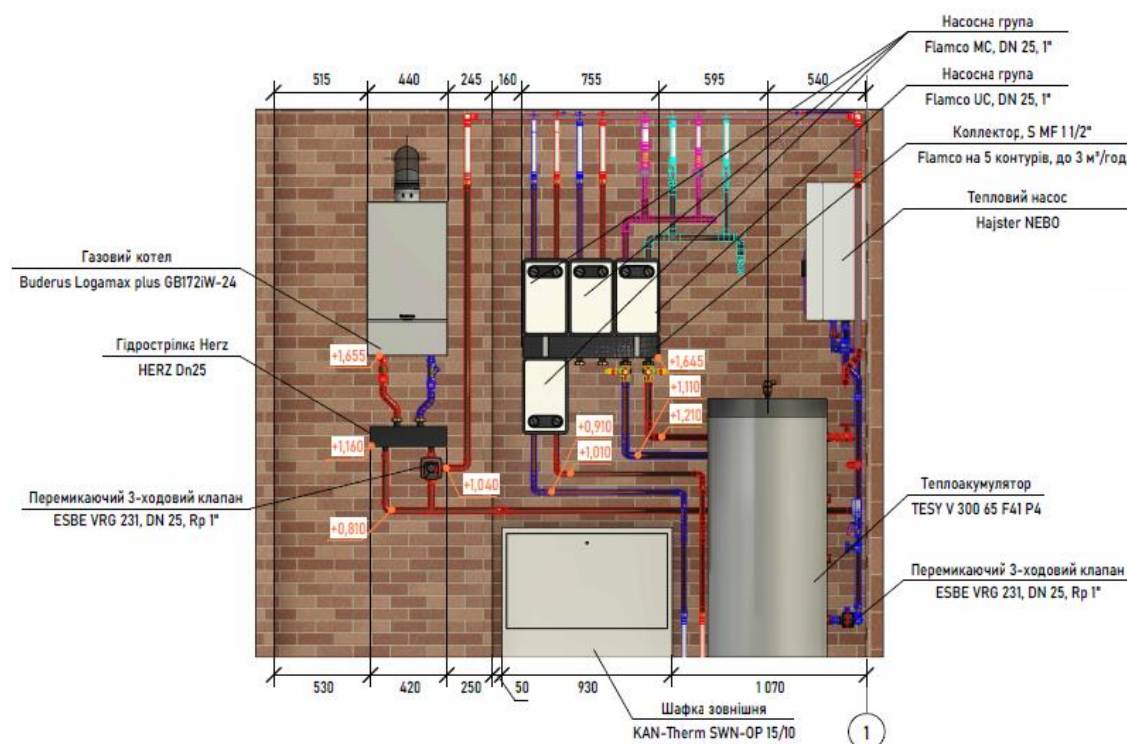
План котельні 1-го поверху. Ч2
